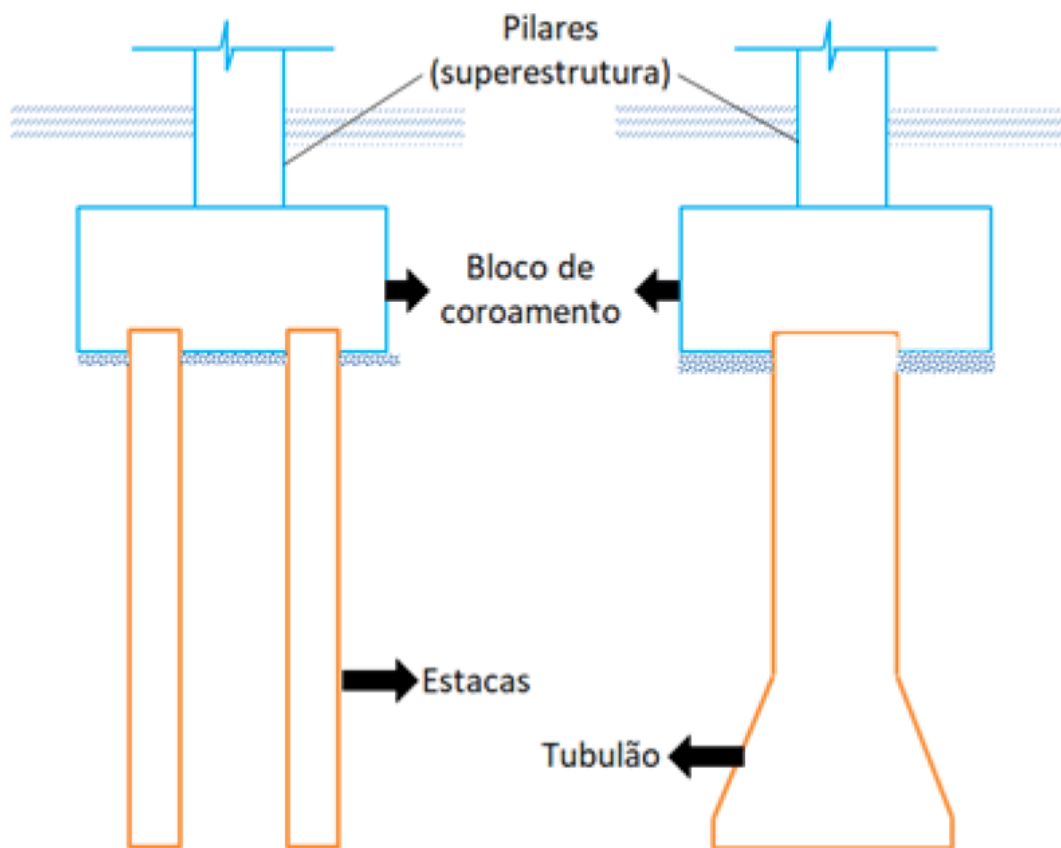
Tipo de Fundações Profundas (Fonte: Nelso Schneider, 2020).
